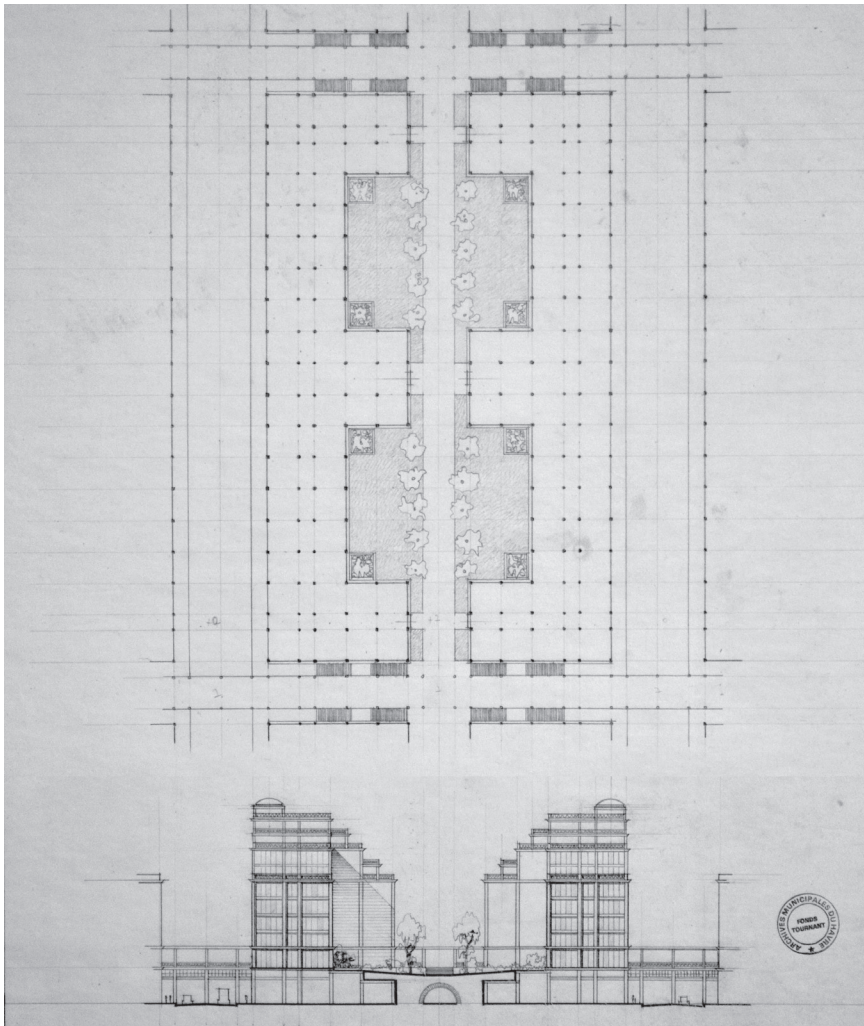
Atelier de Reconstruction de la Ville du Havre. Studi per un isolato urbano; pianta e sezione.
